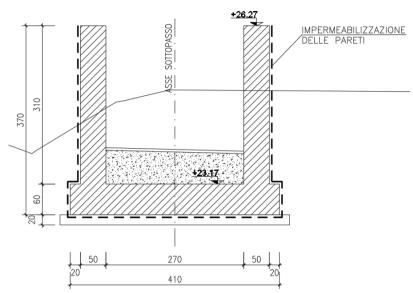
Sezione di calcolo 2 muri di imbocco SL23
